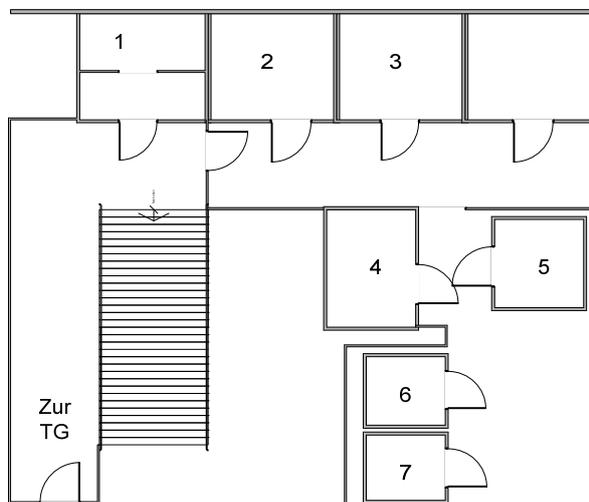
Grundriss-Skizze Untergeschoß
